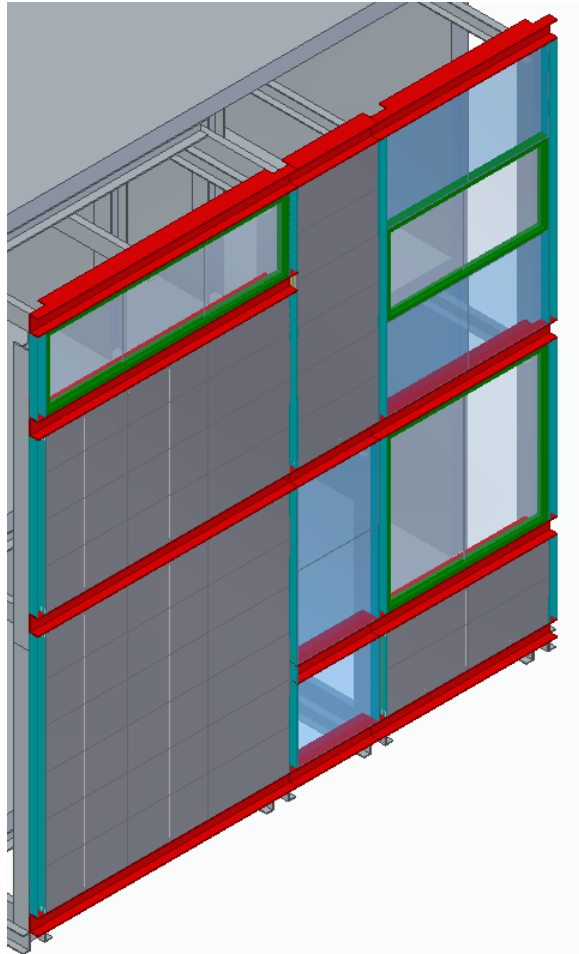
Colocación de Paneles Exteriores, Ventanas y Cristaleras
